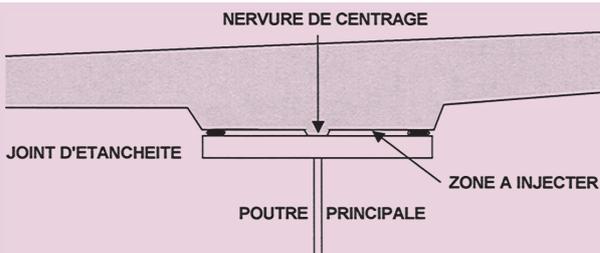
Conditions d'appui des dalles préfabriquées en pleine largeur
